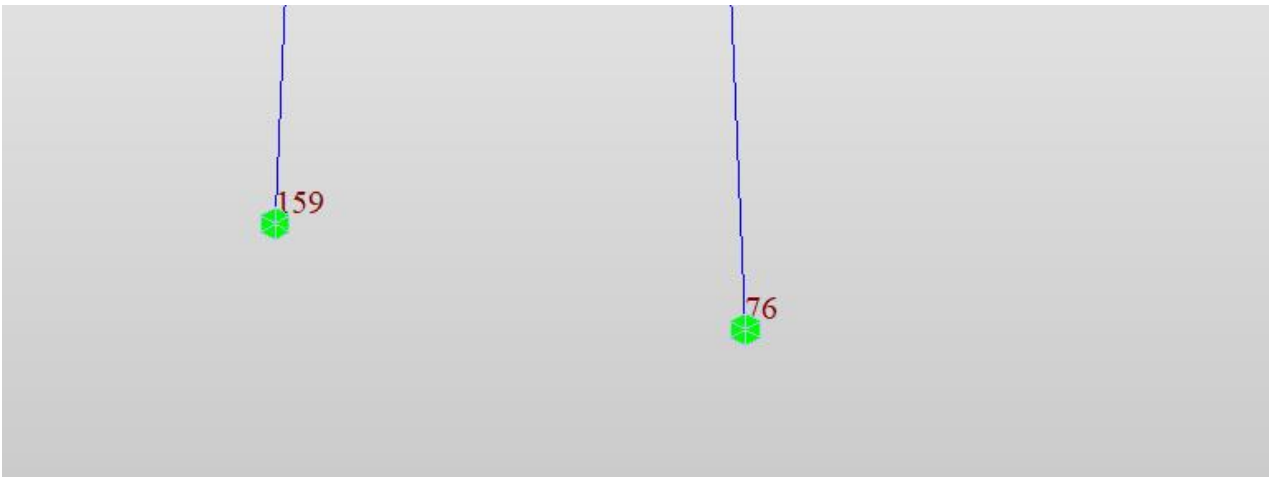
Empotramientos estructura con terreno
